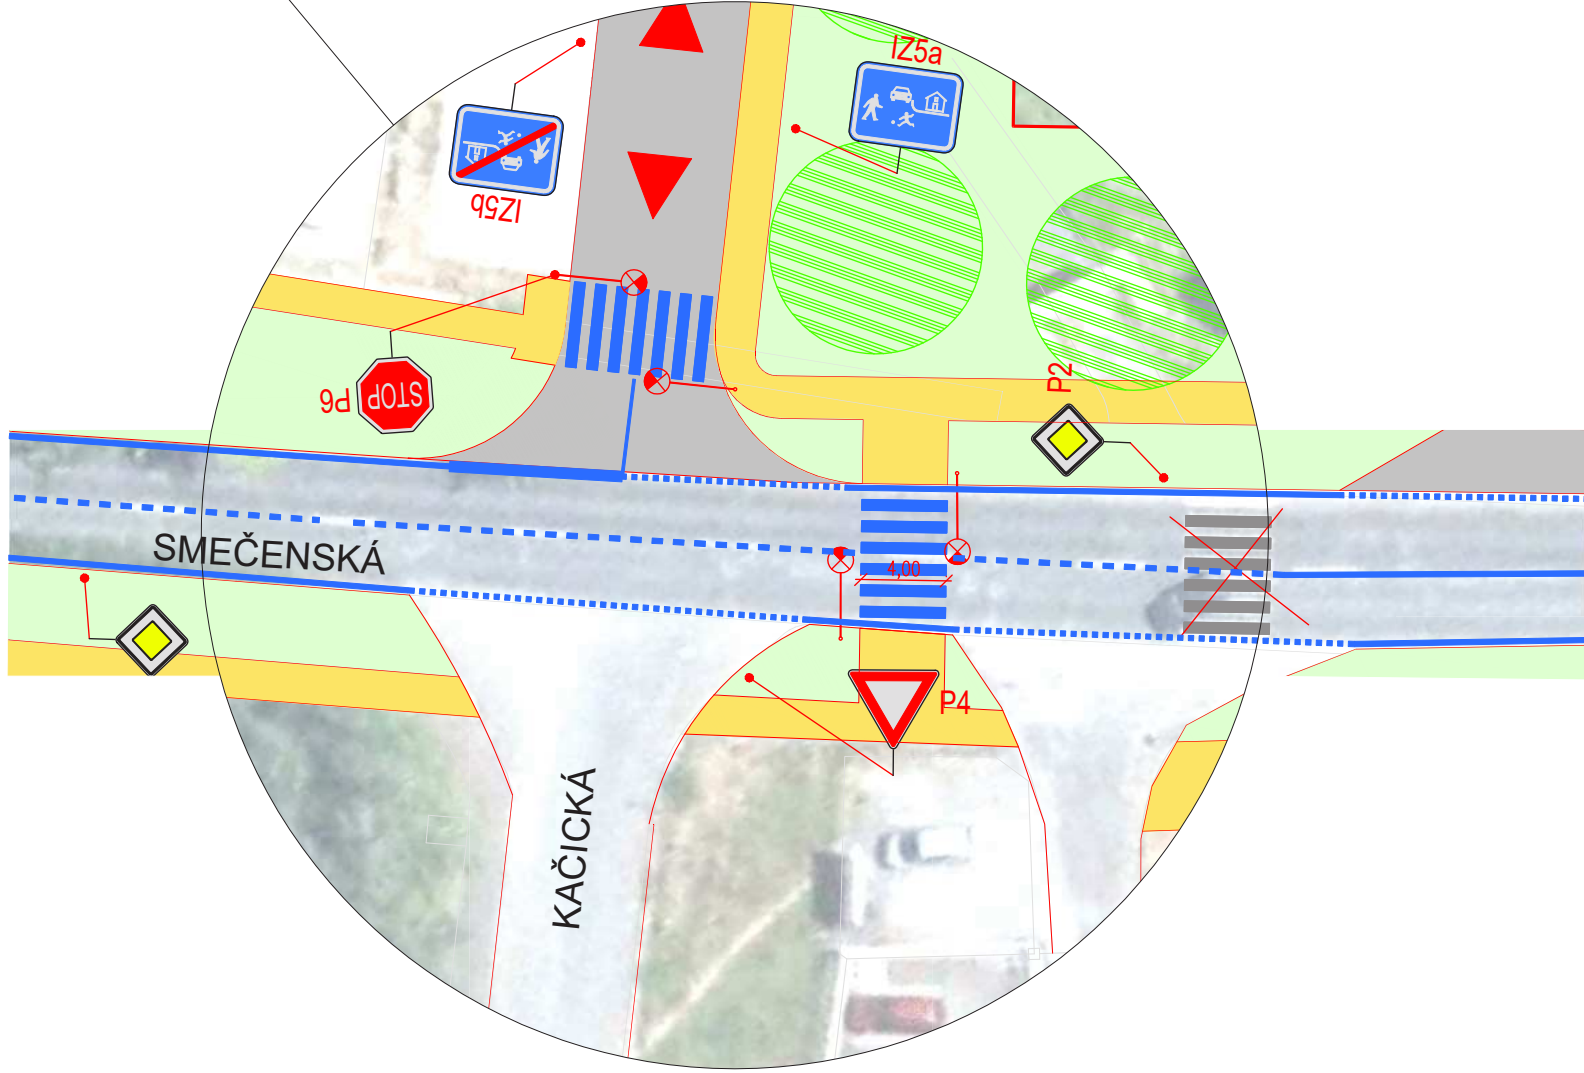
DETAIL KŘÍŽOVATKY SMEČENSKÁ - "NOVÁ"
